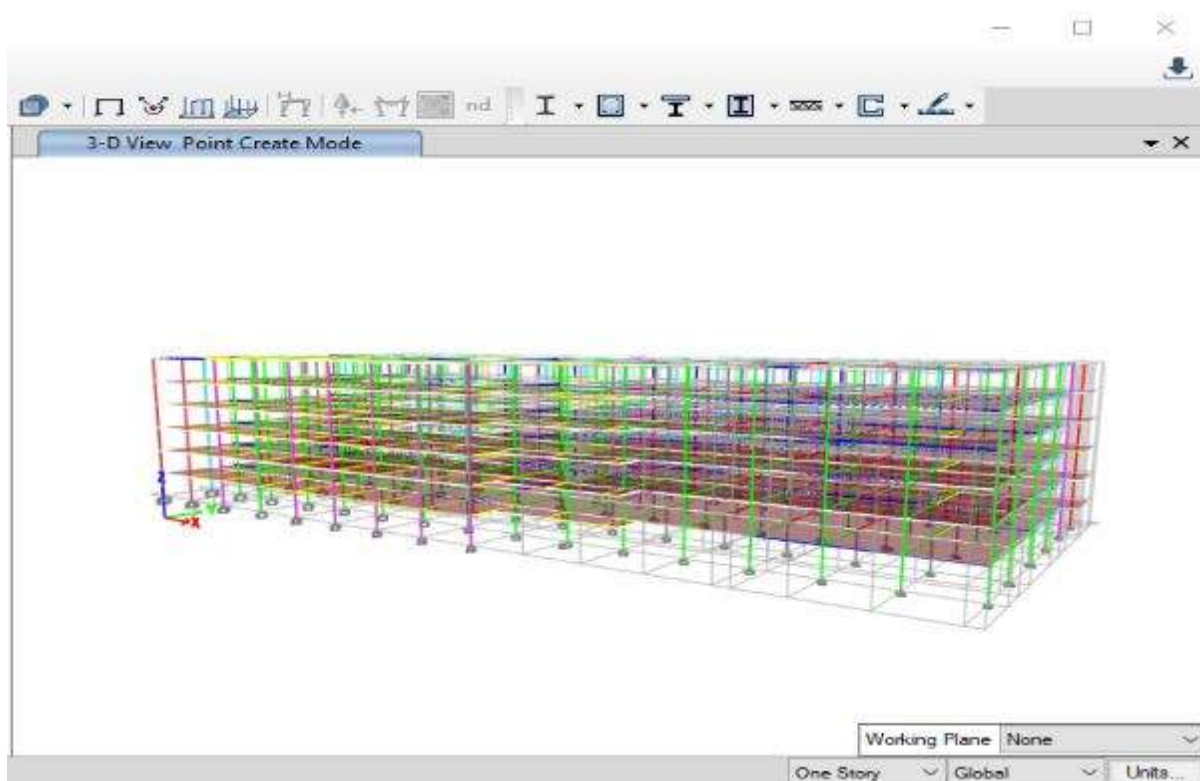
Colocación del Aislador LRB en la interfaz de Aislación.
